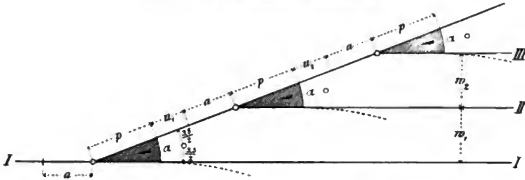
u. 354. Gerade Weichenstraße aus einseitigen Doppelweichen.
